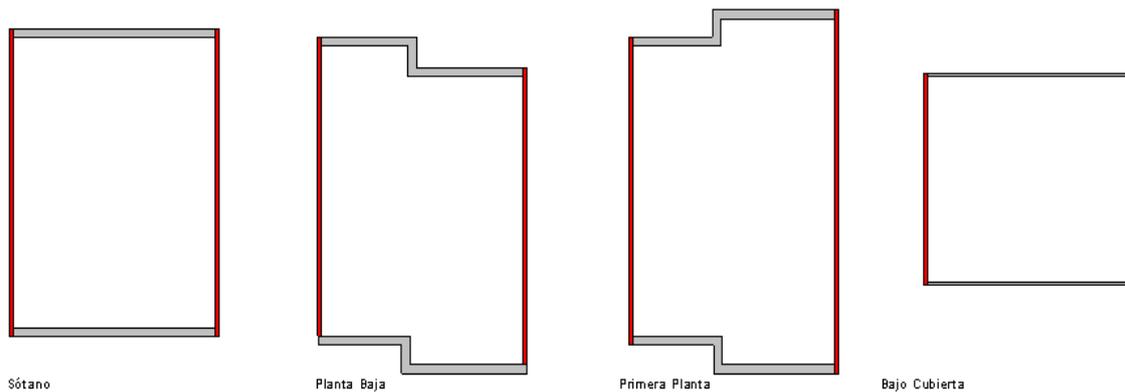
Esquema estructural. (Fuente: elaboración propia)
